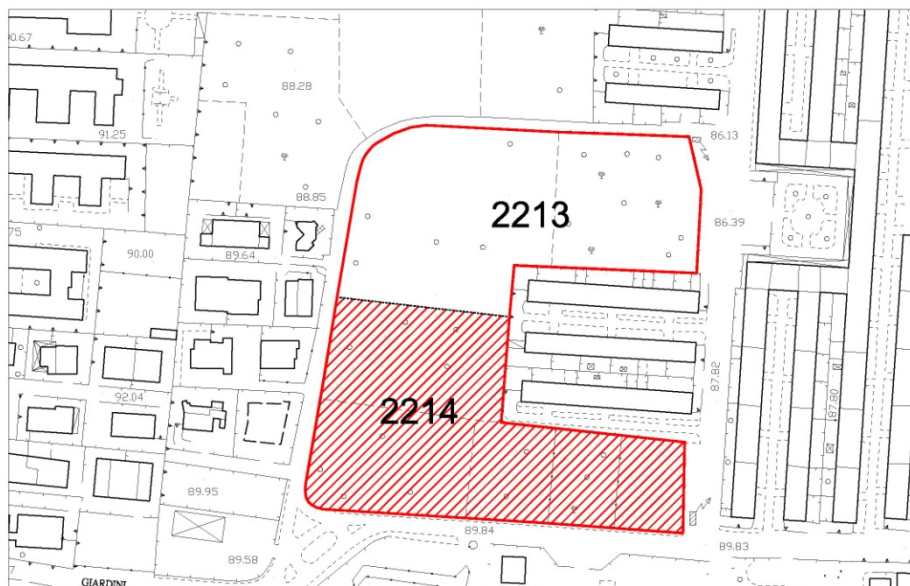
Inquadramento dell'area di intervento su Planimetria Catastale
